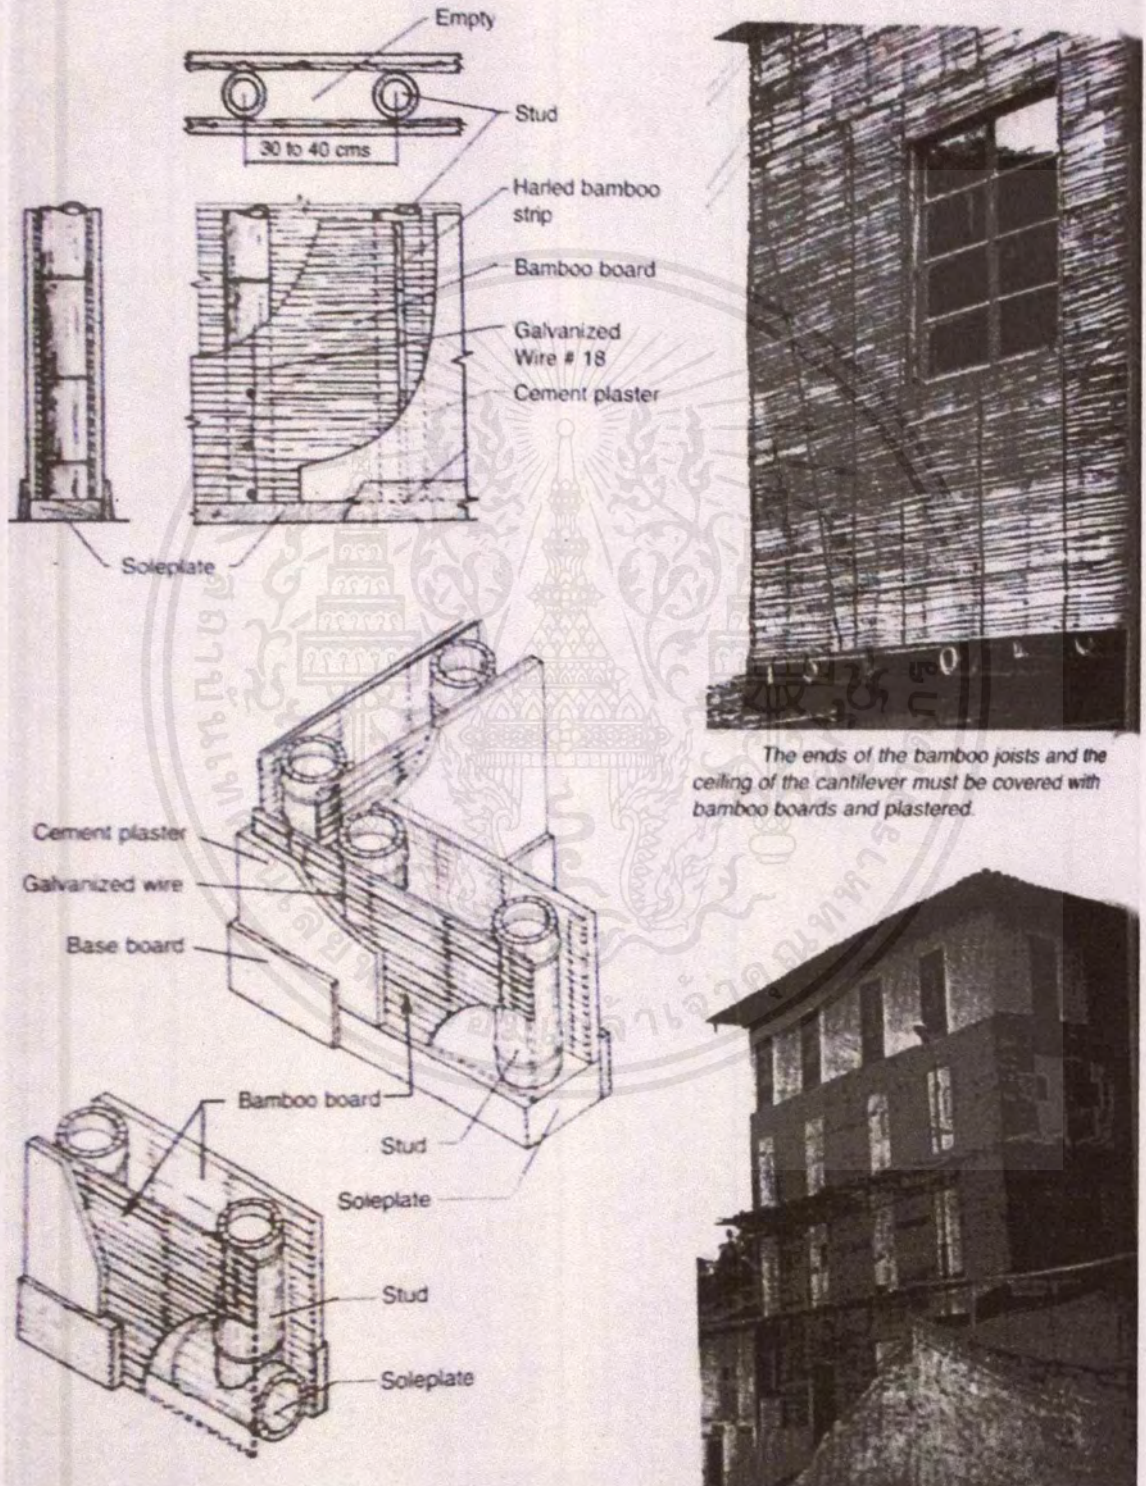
แสดงรายละเอียดโครงสร้างผนังของชาวโคลัมเบียที่ใช้ไม้เป็นโครงทาบปิดทับด้วยดินเหนียว
